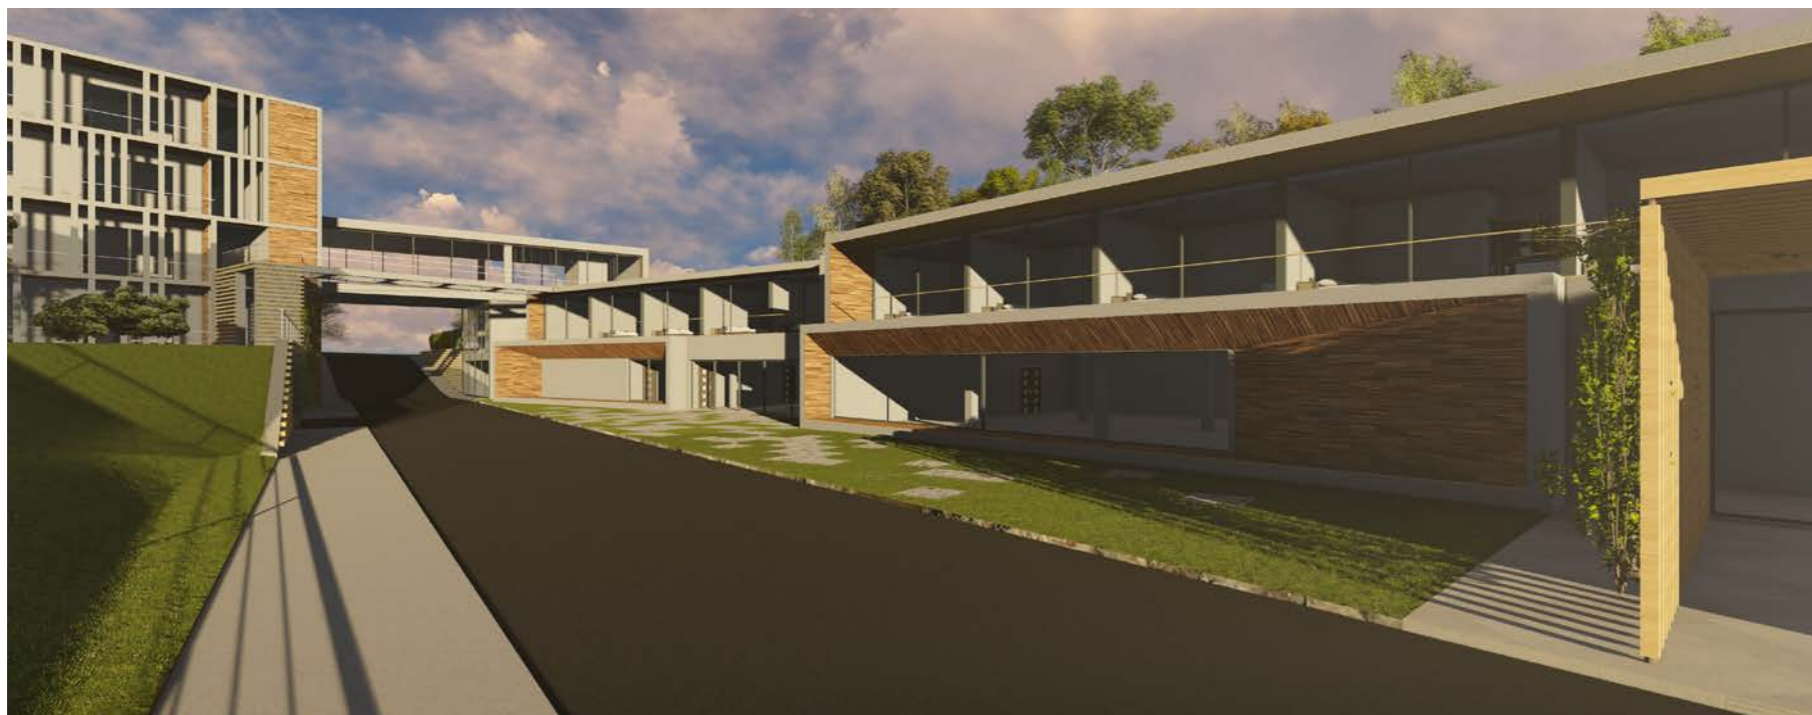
Vista 4 – Veduta dell'ingresso alla struttura alberghiera e all'edificio ipogeo. I prospetti con rivestimento in legno e parapetti in vetro.
